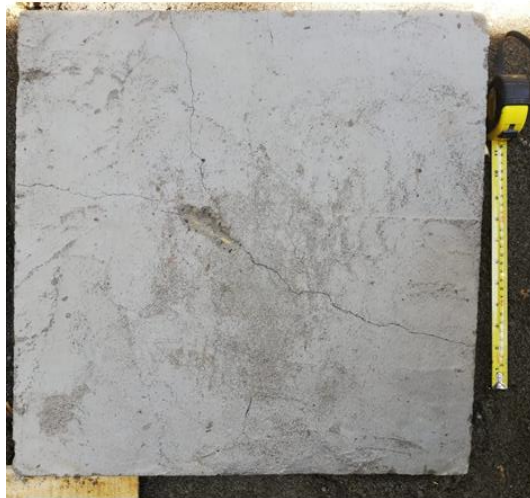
Losa de concreto con refuerzo de malla soldada fisurada.
